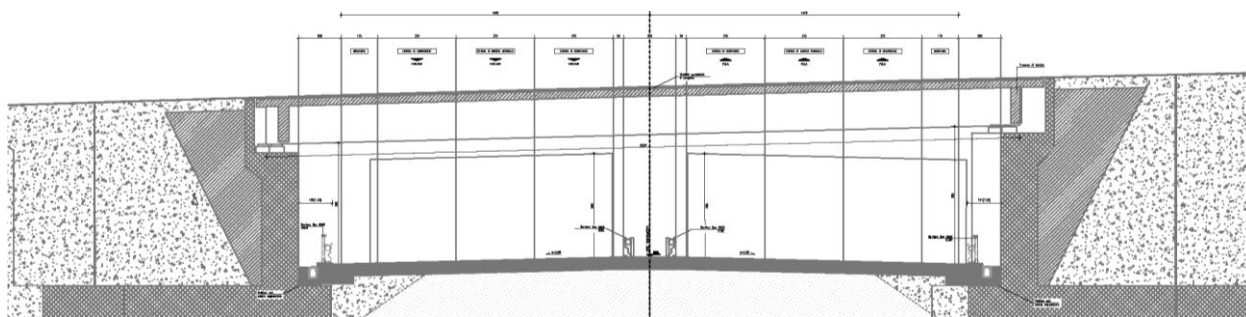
Sezione tipologica con opere d'arte – cavalcavia
